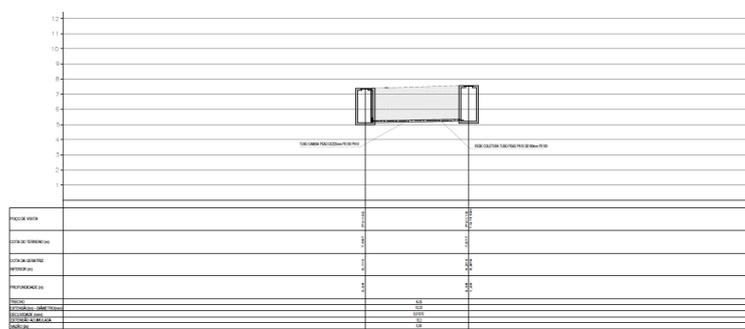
Perfil longitudinal da travessia SB-T03 - PV-119 ao PV-122
